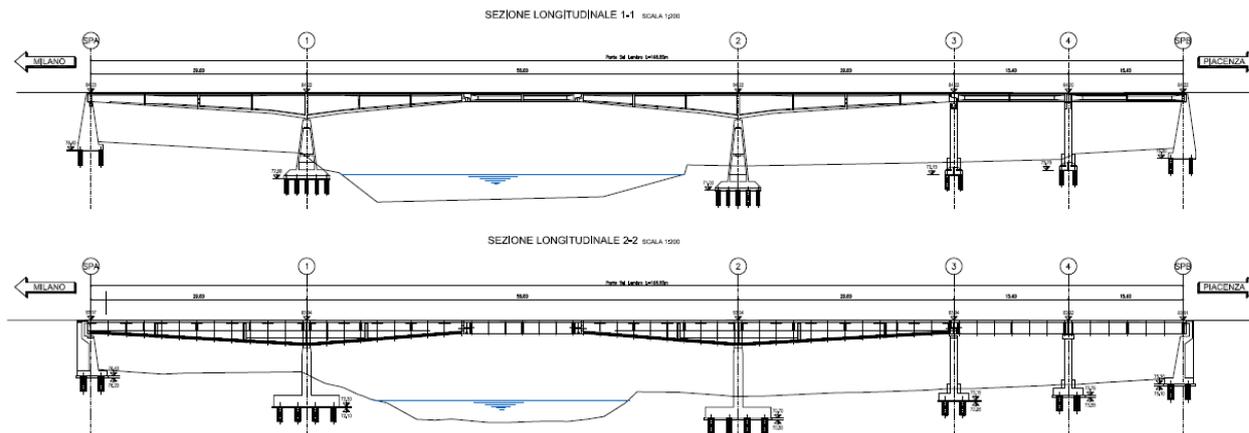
Ponte sul Lambro – Pianta e sezione longitudinale
